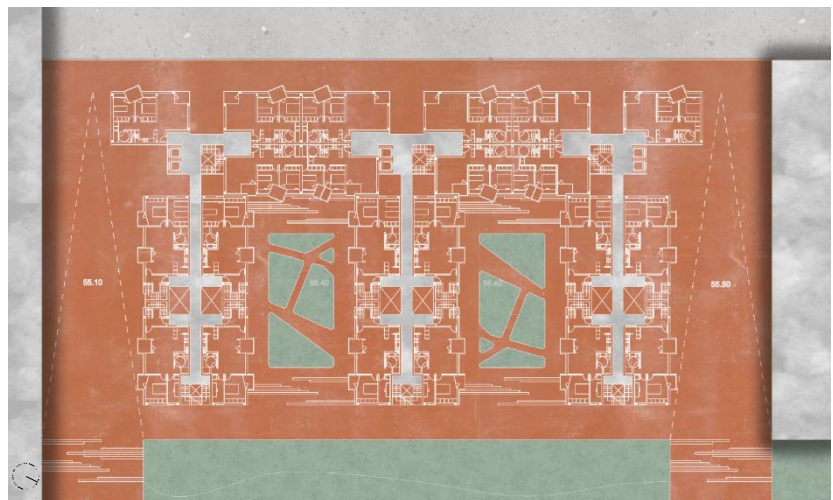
| Planta piso tipo 1:200 galerias exteriores
